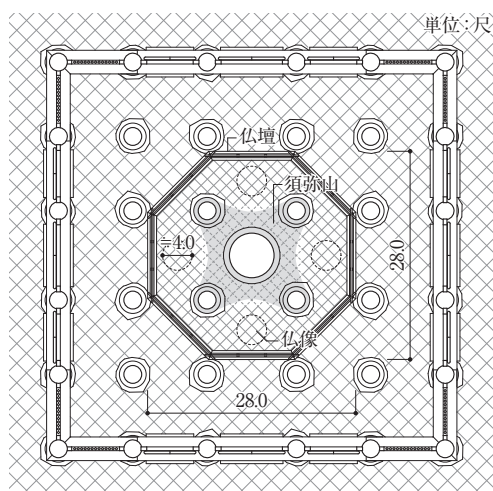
八角形仏壇検討案 初重内部平面図
